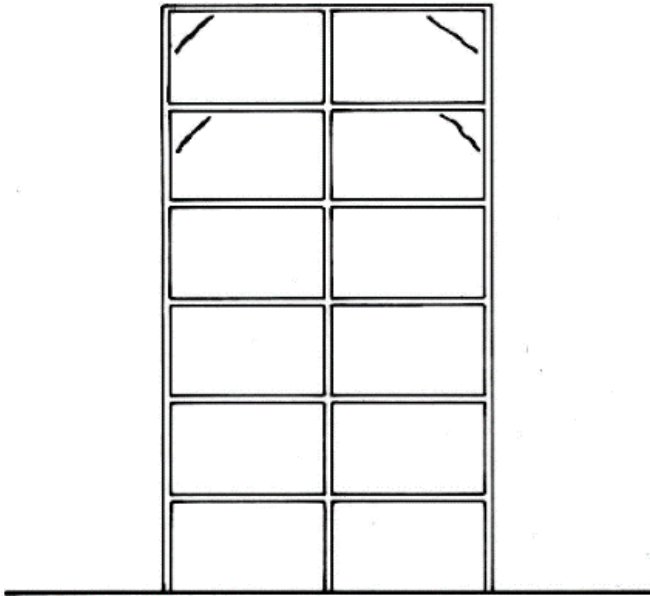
Fissuras devido a movimentação higrotérmica
